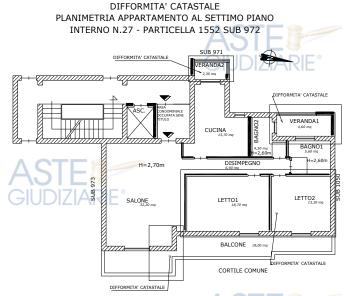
planimetria delle difformità catastali dell'appartamento pignorato al settimo piano
